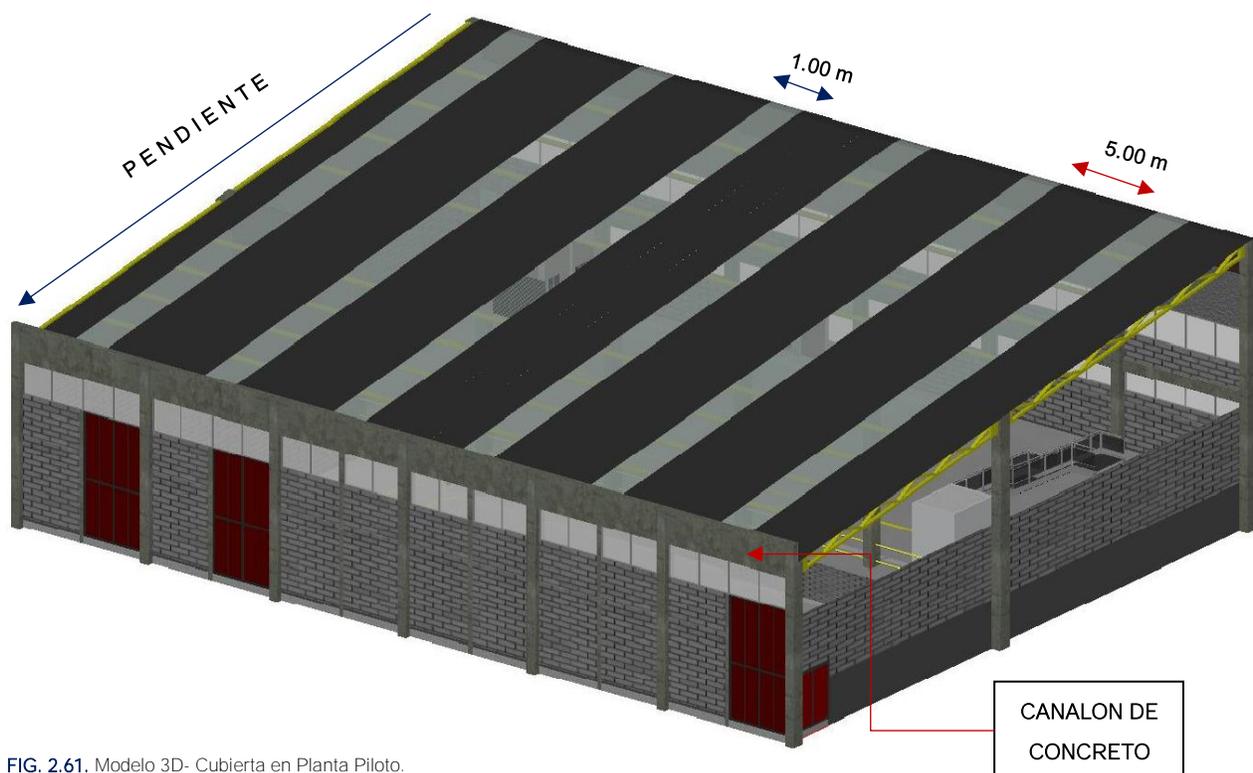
Modelo 3D- Cubierta en Planta Piloto.
